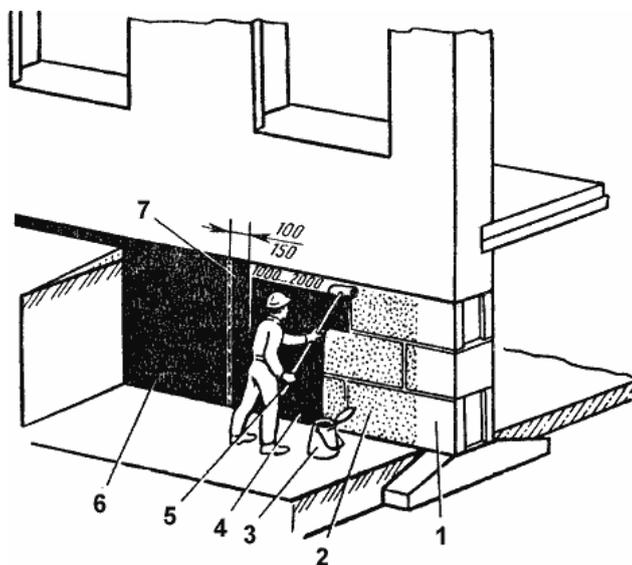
Нанесение окрасочной гидроизоляции на поверхность фундамента:
